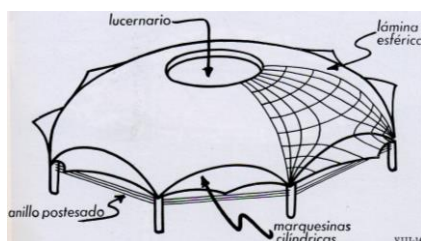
Solución constructiva mercado de Algeciras empleada posteriormente en la bodega Tío Pepe de González Byass (Jerez)
